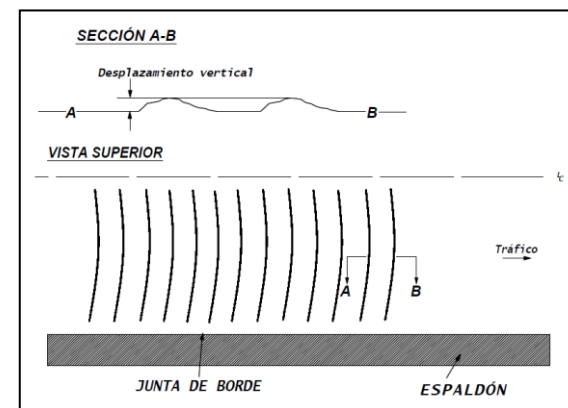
Esquema Corrugación– Pavimento Flexible
